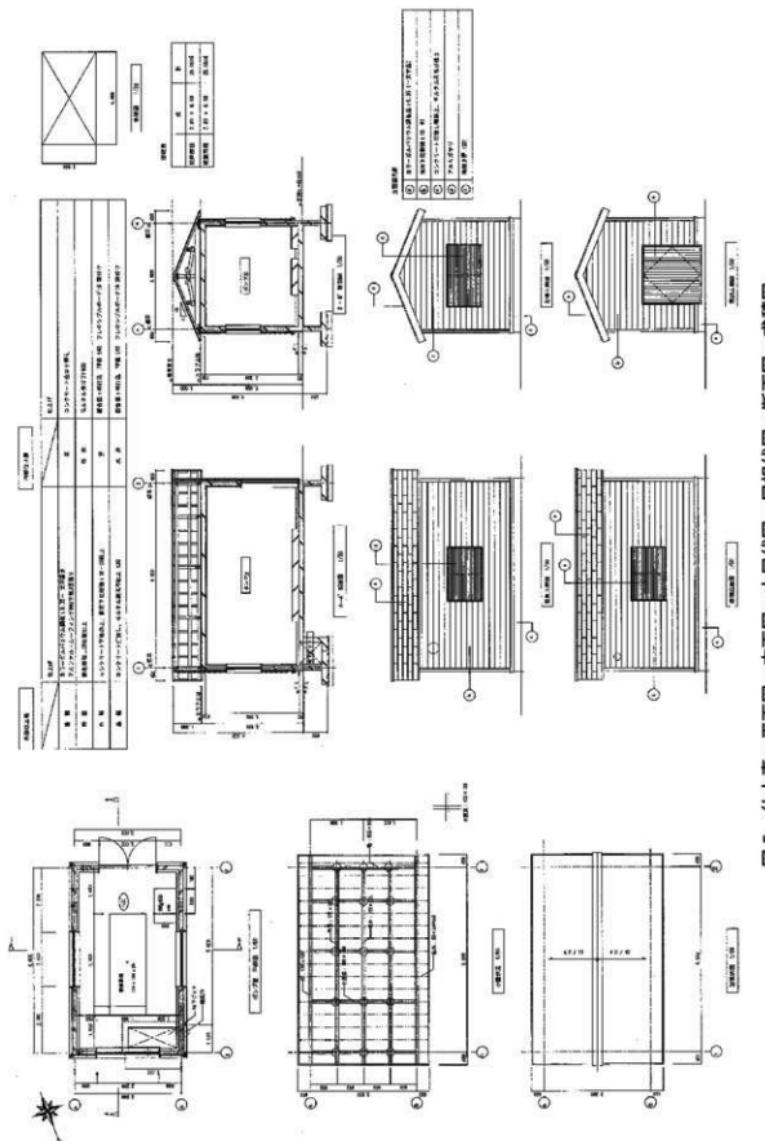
仕上表・平面図・立面図・小屋伏図・屋根断図・断面図・求積図
